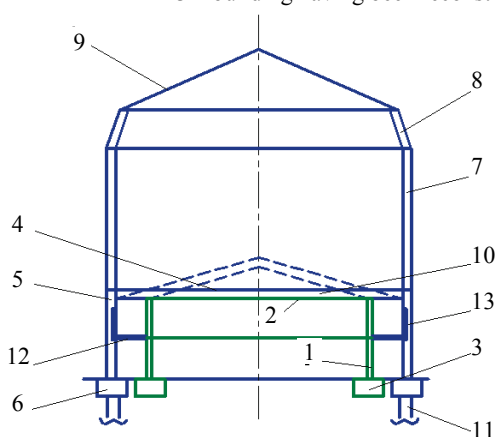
Схема надстройки вторичного здания, объединяющего старые здания:
